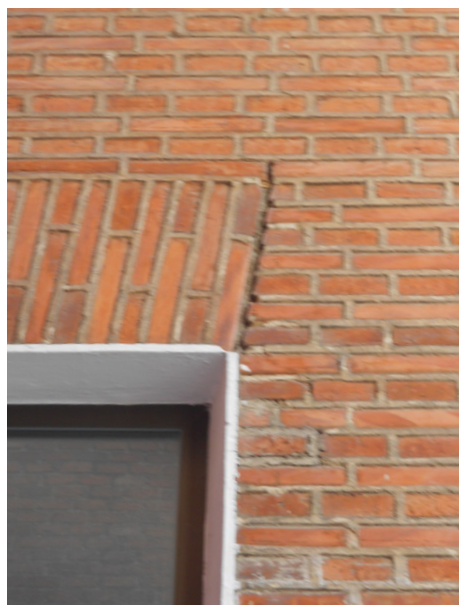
Grieta en la unión del arco de descarga con el muro.
